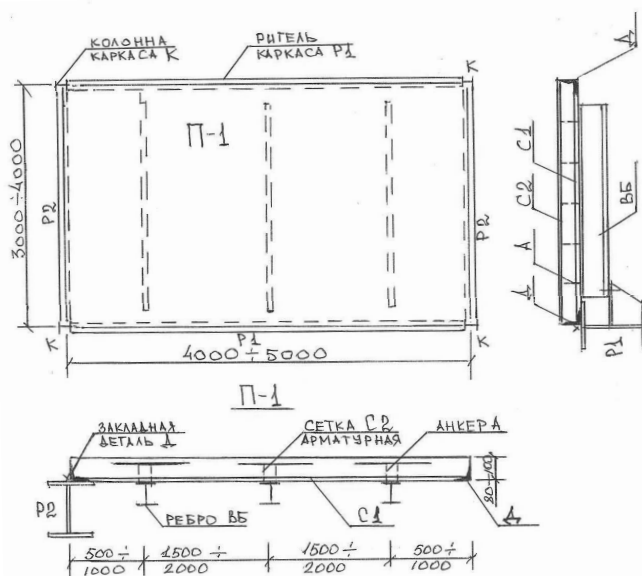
Конструктивное решение сборного комбинированного перекрытия
